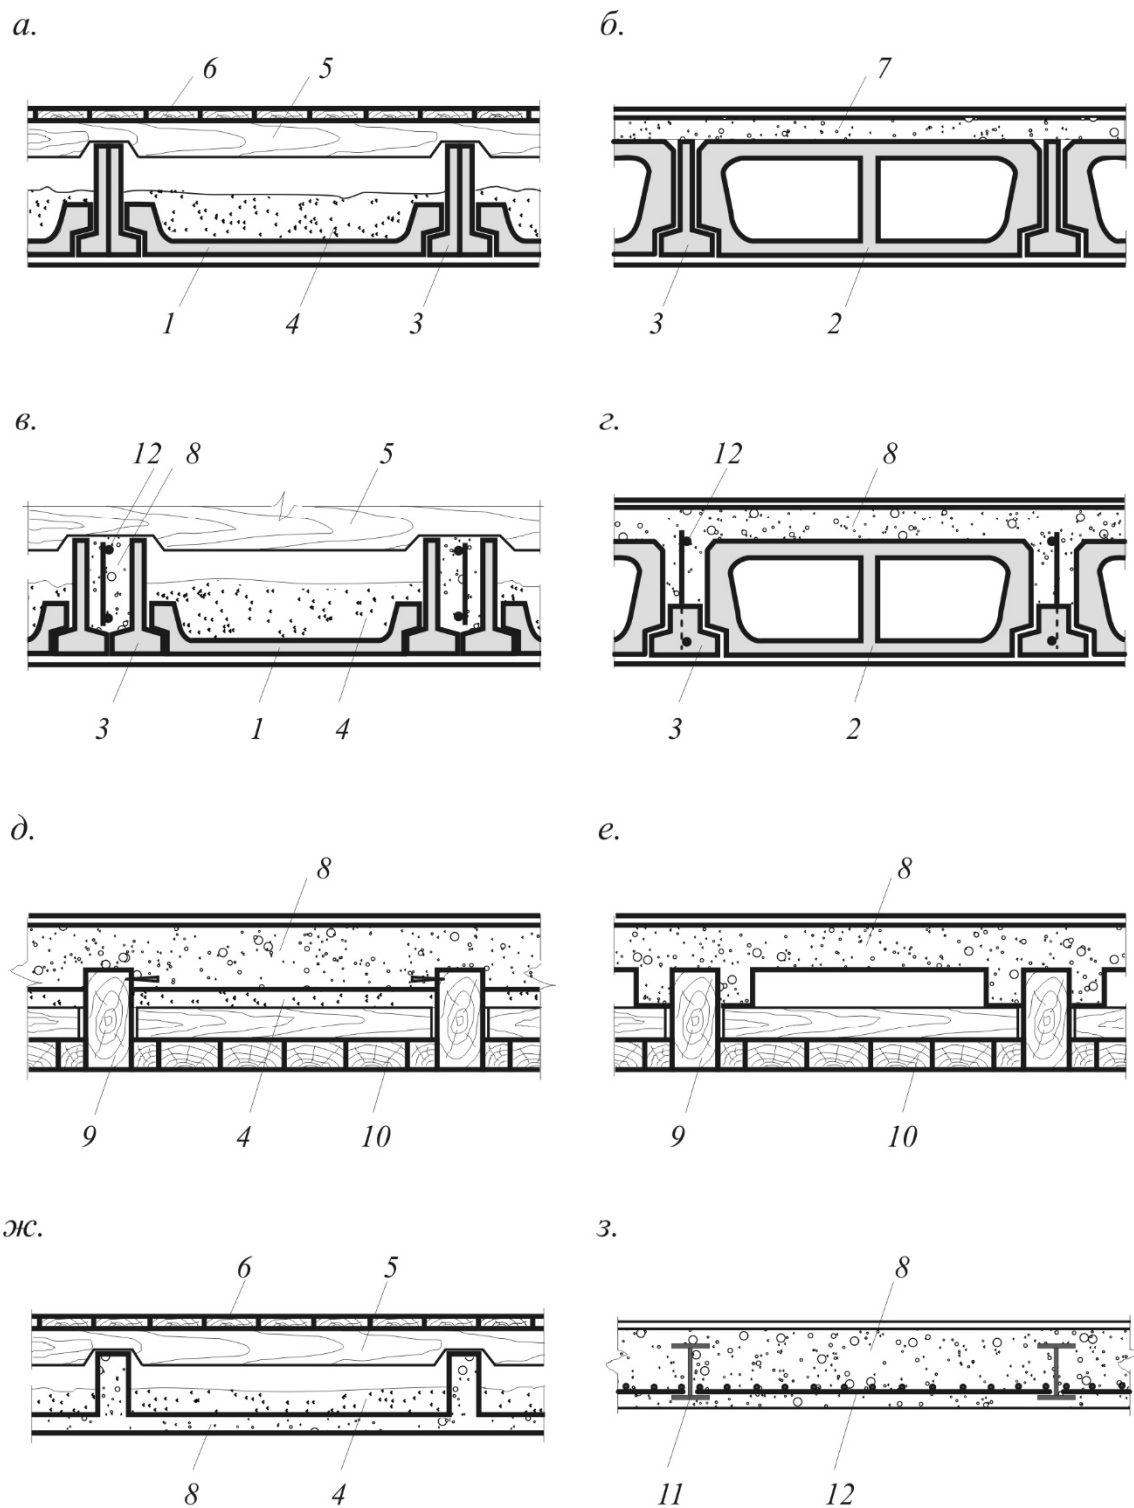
Конструкции вновь устраиваемых перекрытий:
